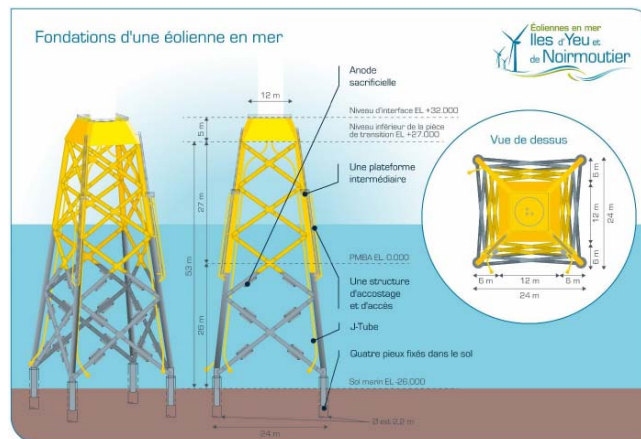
Fondation des éoliennes sur jacket. source : dossier
